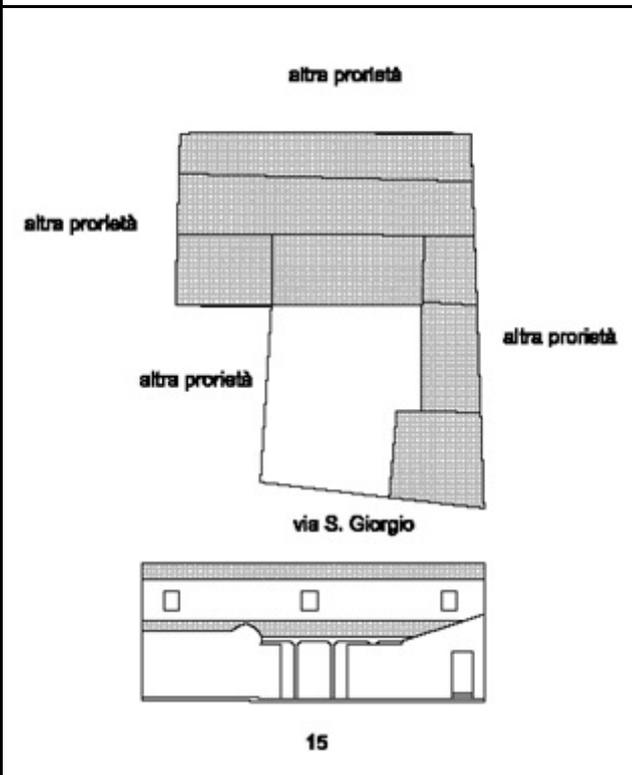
Isolato 11, lotto 15. Casa a corte antistante
